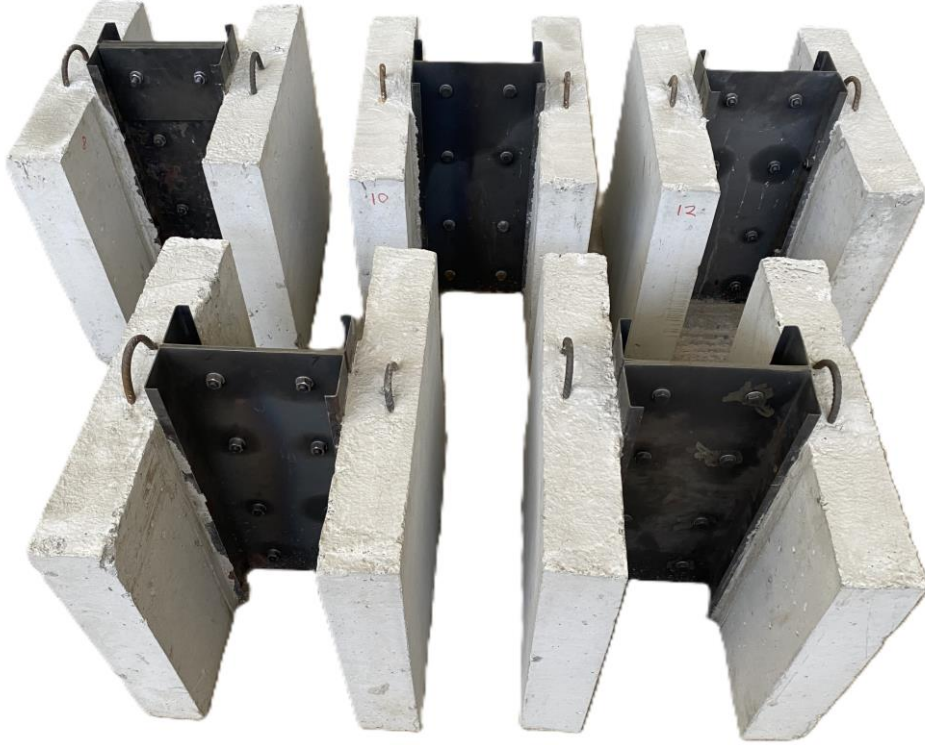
Beton dökümüne hazır hale getirilmiş PO-PL-ISO elemanı
